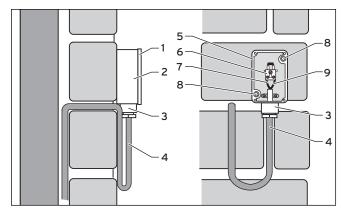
Montage des Außenfühlers und Einbaulage
